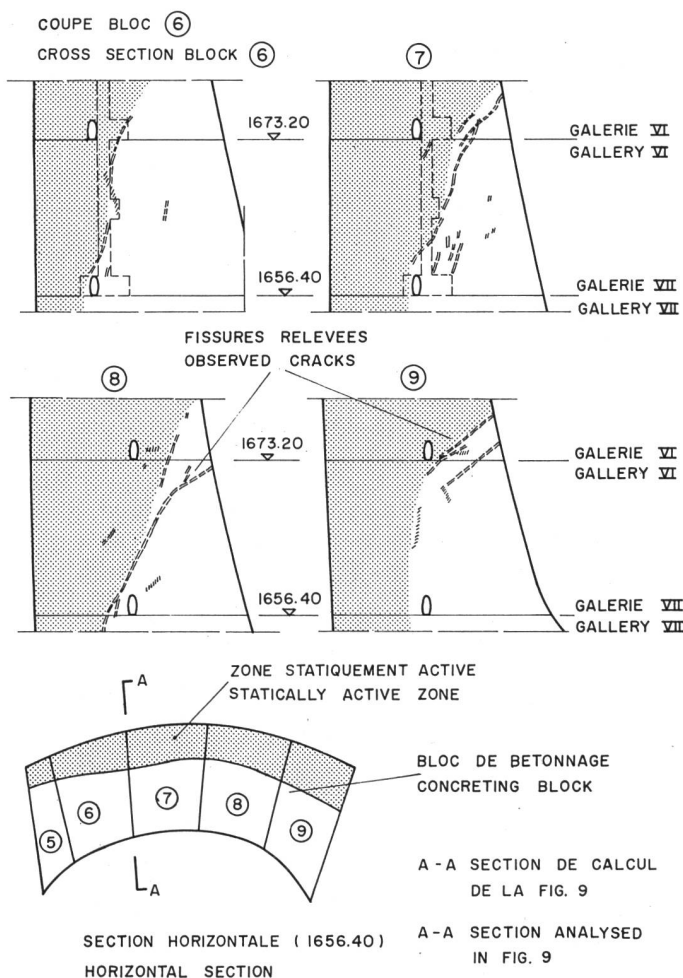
Barrage à l'état actuel fissuré. Fissuration relevée déterminant la section active encore disponible.
